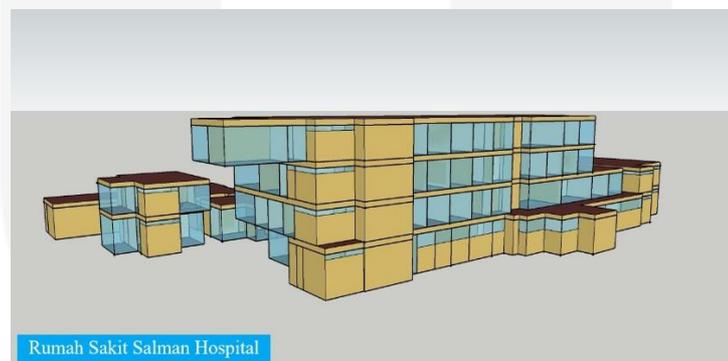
2 Denah Bangunan Rumah Sakit Salman Hospital
